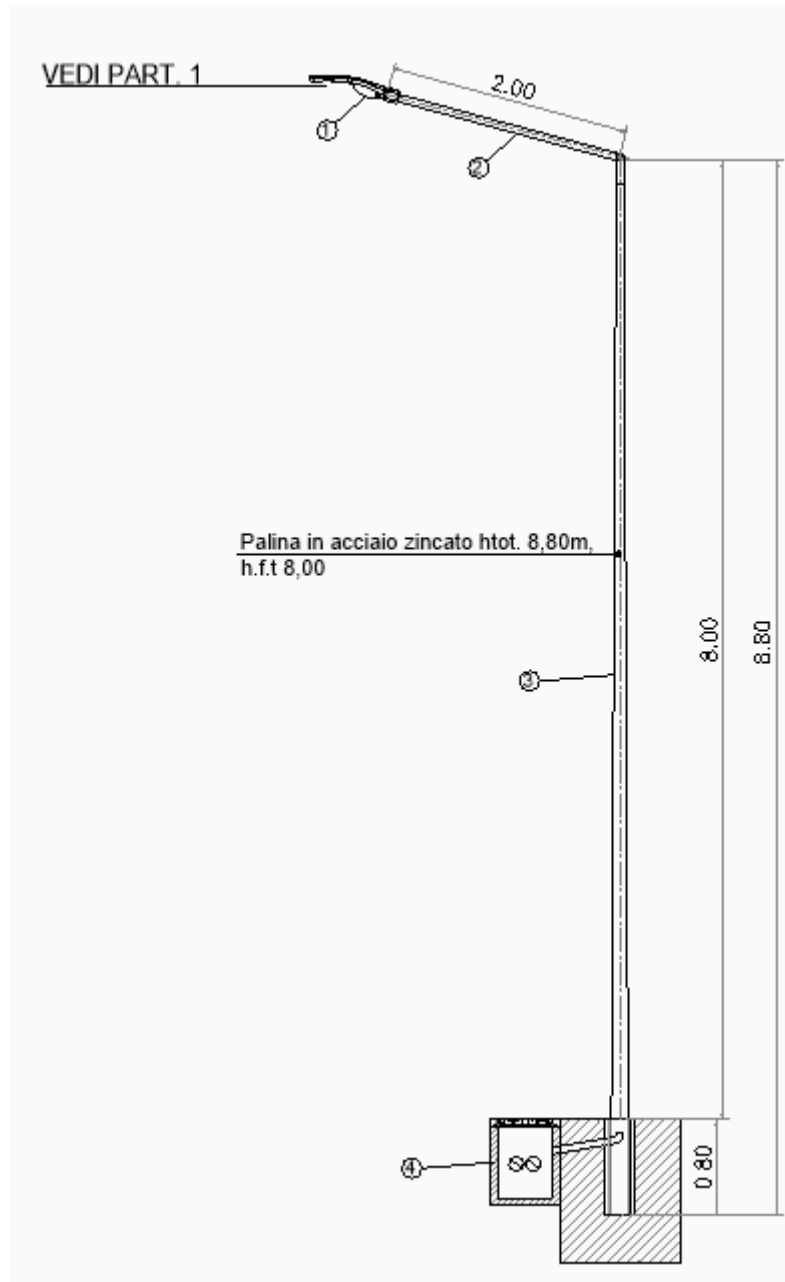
Sezione - Palina Illuminazione & Blocco di fondazione
